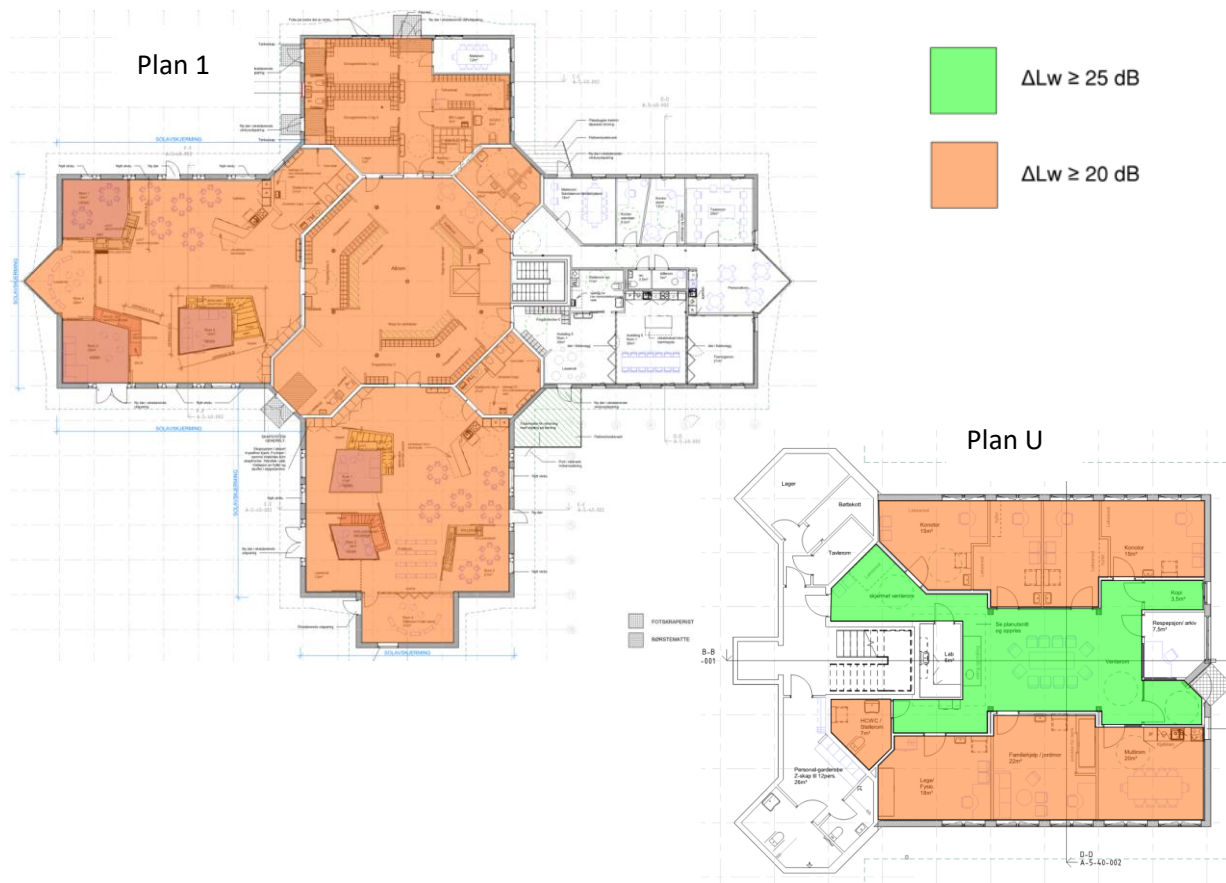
Plan 1 og Plan U. Oversikt av type dekke/etasjeskiller. Behov for splitt i gulv på grunn er markert med rød linje.
